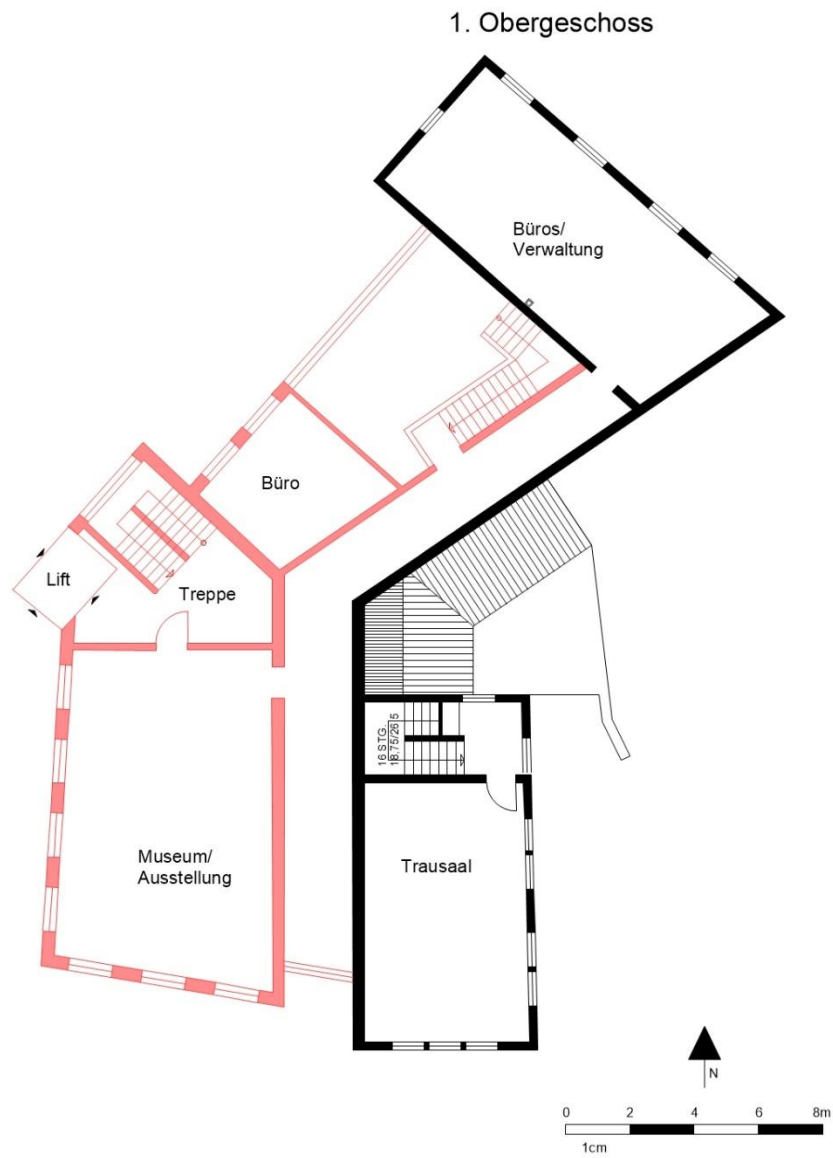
Grundriss der Gebäude der Kirchgasse 1 und 3 (1.OG)
